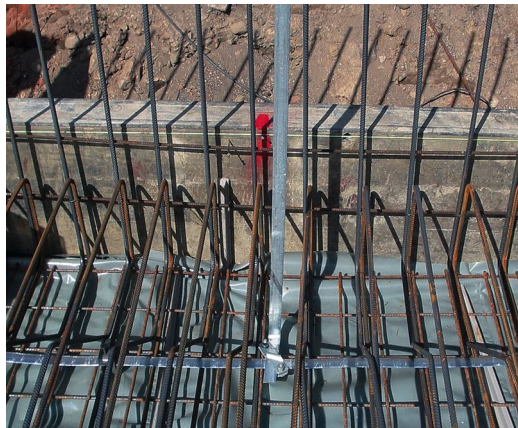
Waagrecht verlegter Bandstahl in der Fundamentbewehrung
